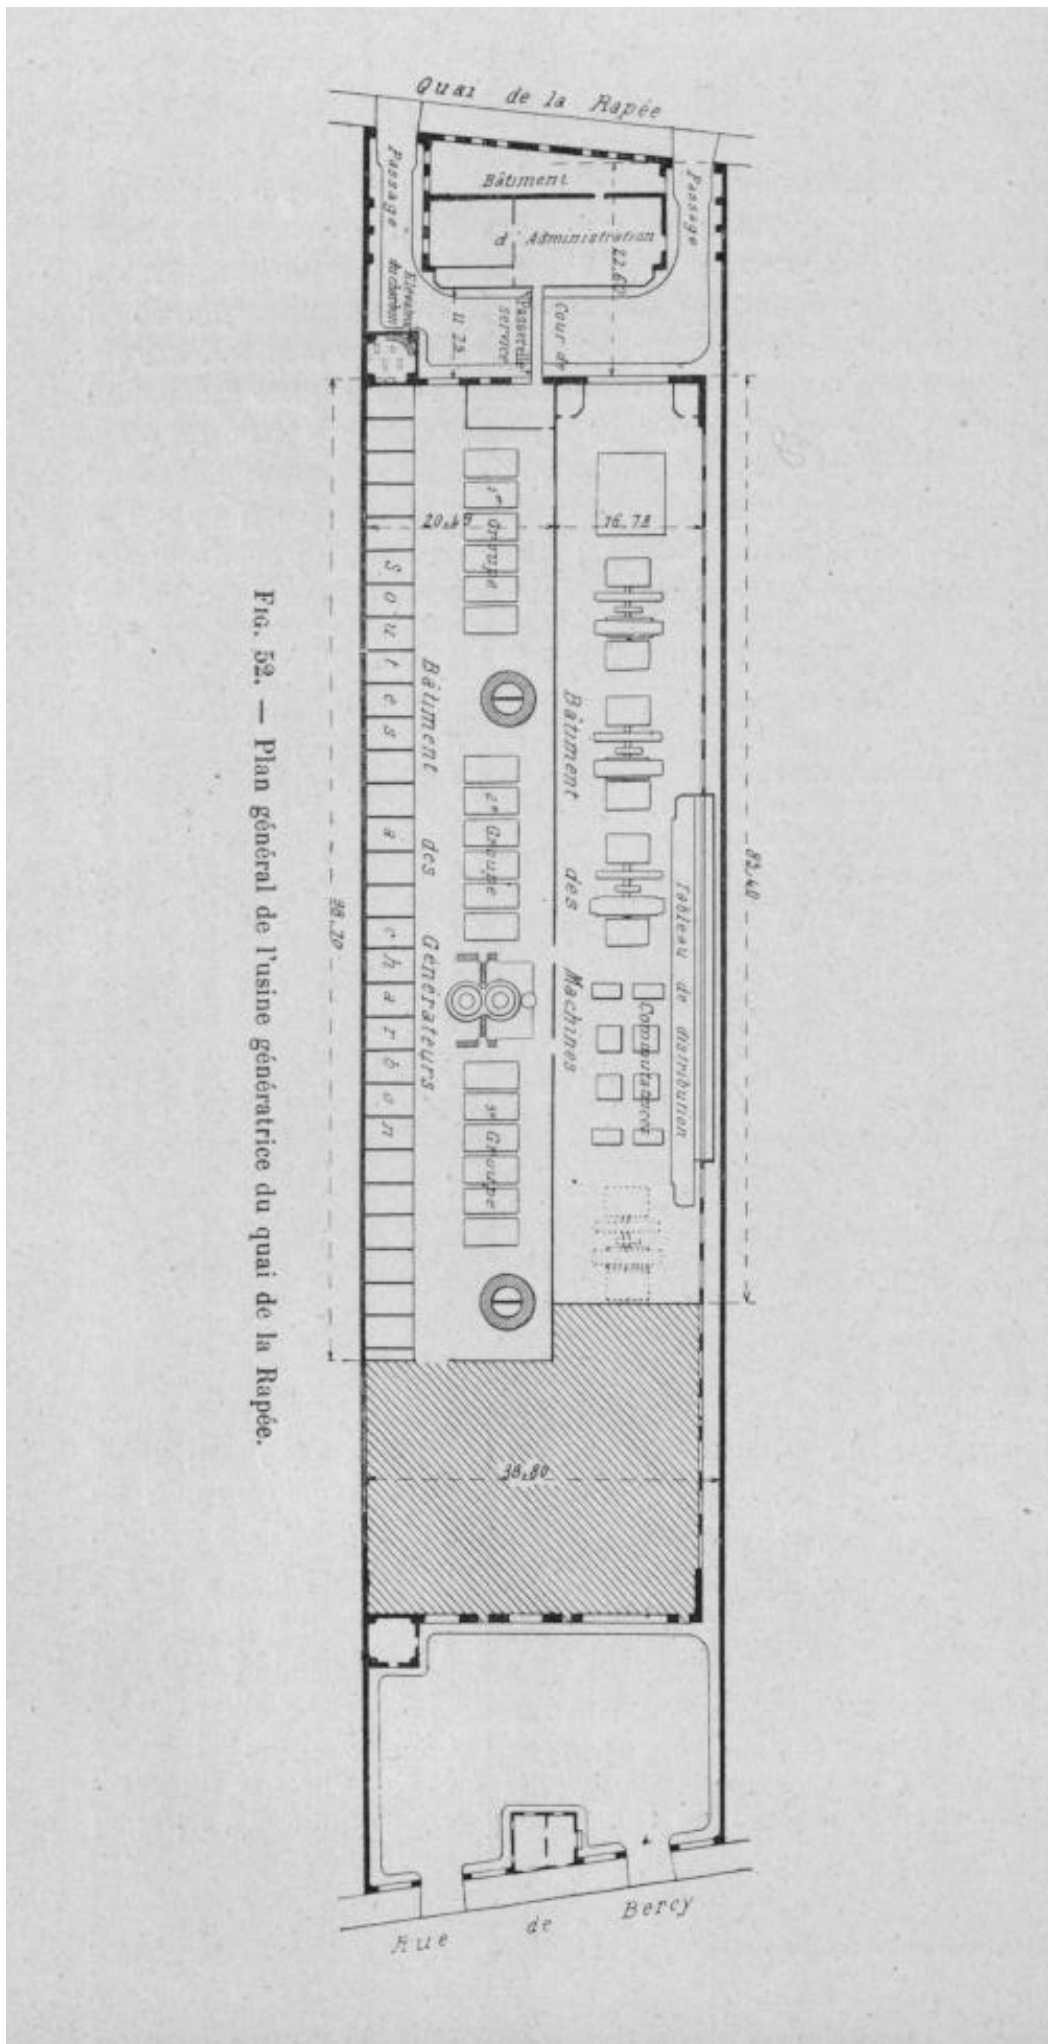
Plan général de l'usine génératrice du quai de la Rapée.
